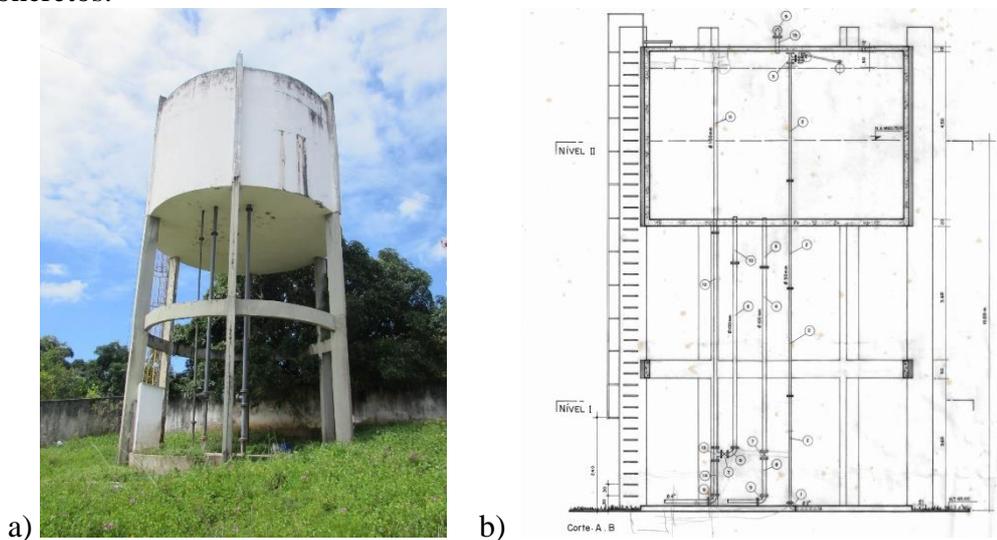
a) Foto do reservatório elevado; b) Corte da planta baixa
